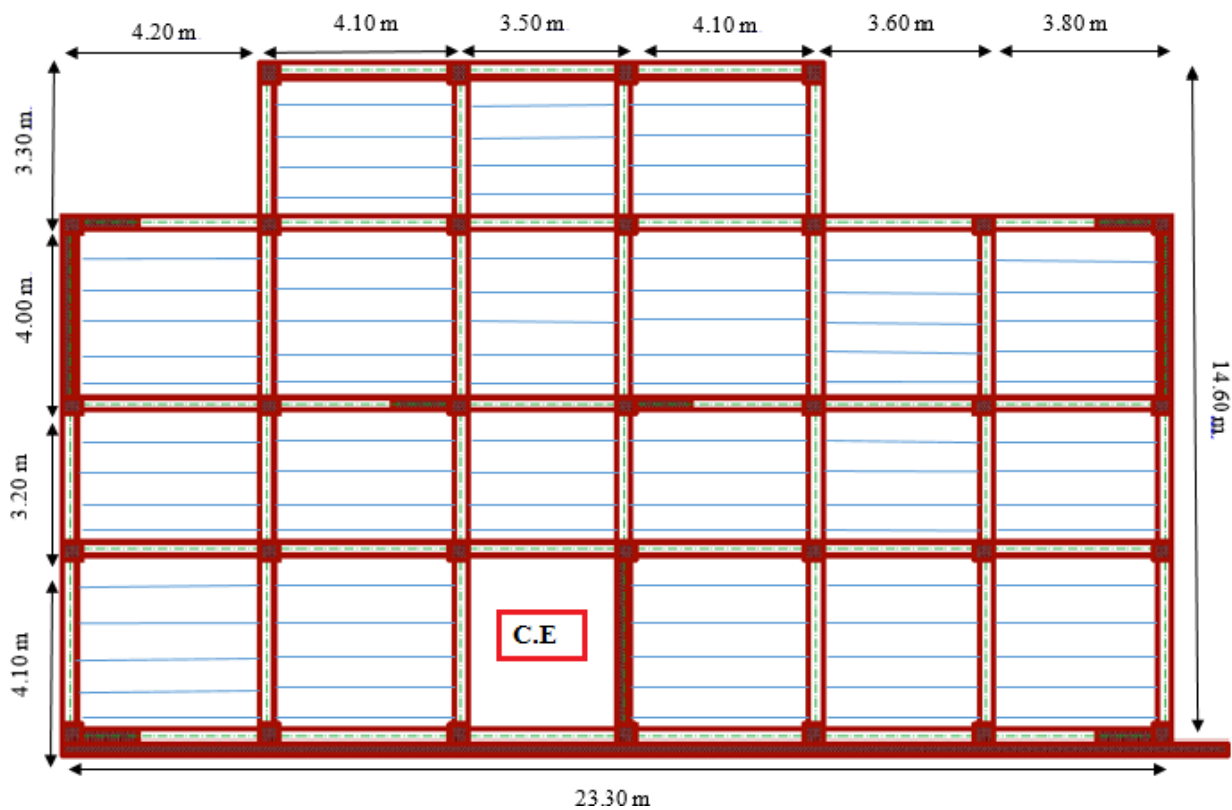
Schémas de disposition des poutrelles du plancher 16+4.
